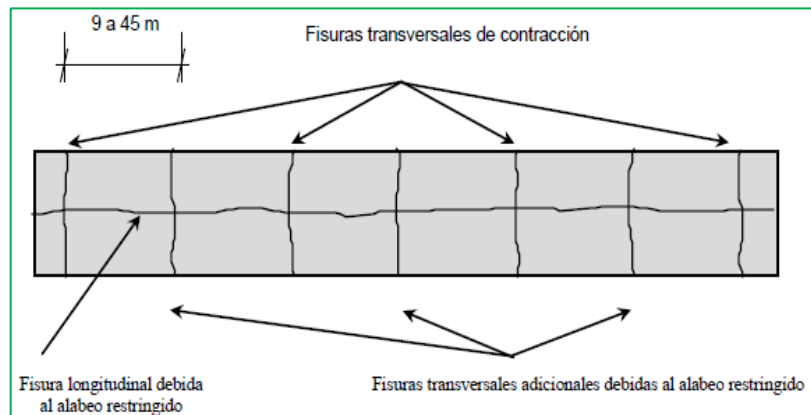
a Vista en planta del Pavimento de Concreto sin Juntas. Fuente: Pavimentos de Concreto para carreteras. (Ref. Bibliografía 5)
